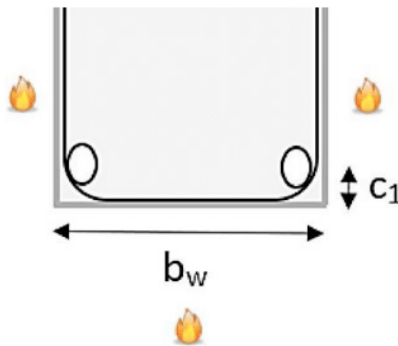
Dimensões mínimas de largura (b_{min}) e distância entre o eixo da armadura longitudinal inferior e a face do concreto exposta ao fogo (c_1).
